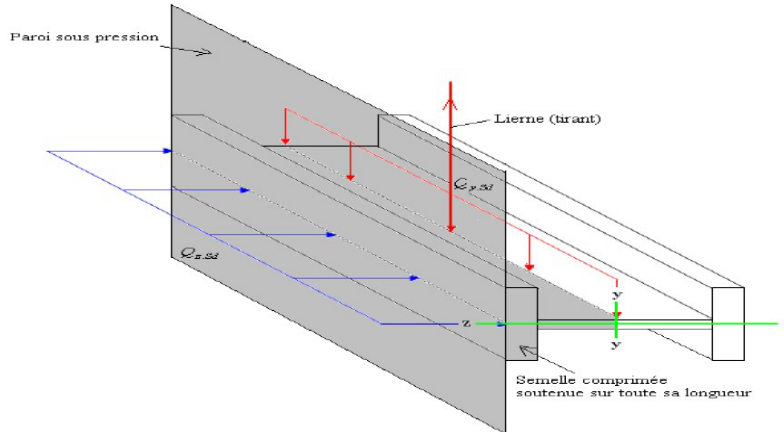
Semelle comprimée soutenue sur toute sa longueur.
